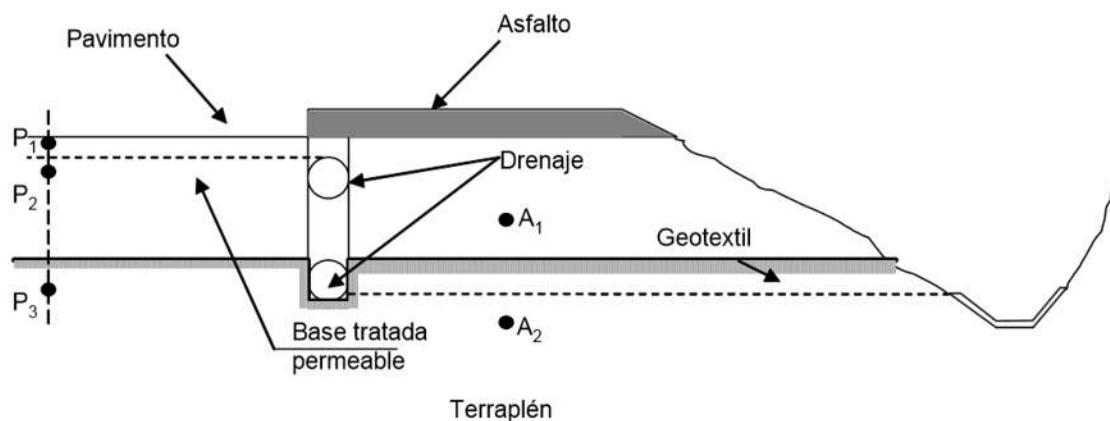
Geometría y puntos de referencia de un pavimento drenado (Alonso, 1998).
